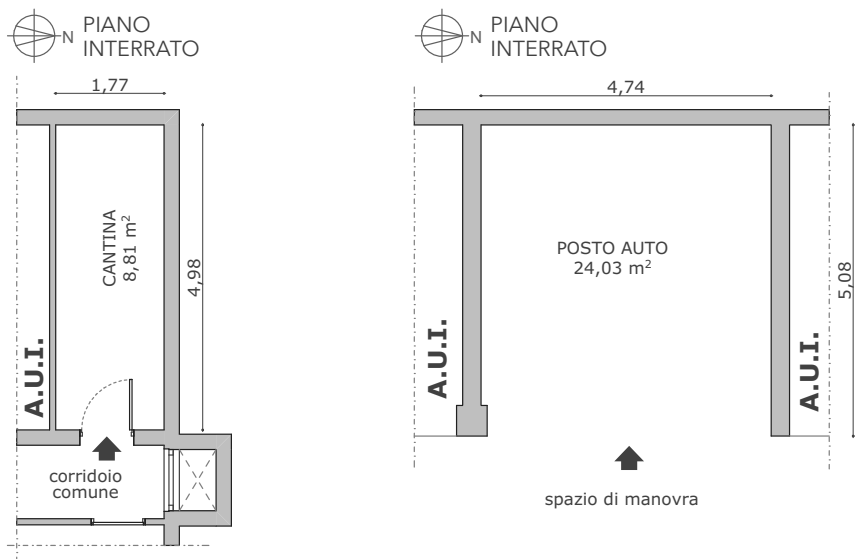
Planimetria cantina e posto auto PIANO INTERRATO.
